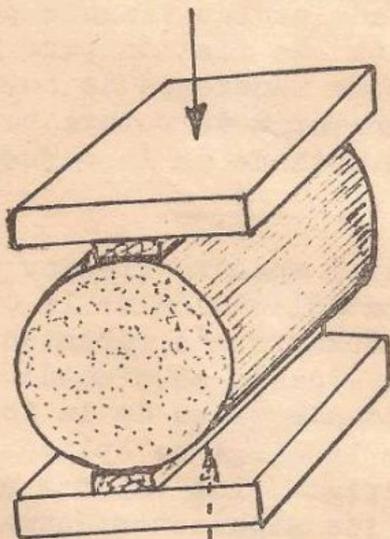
ENSAYO DE TRACCION POR COMPRESION.
